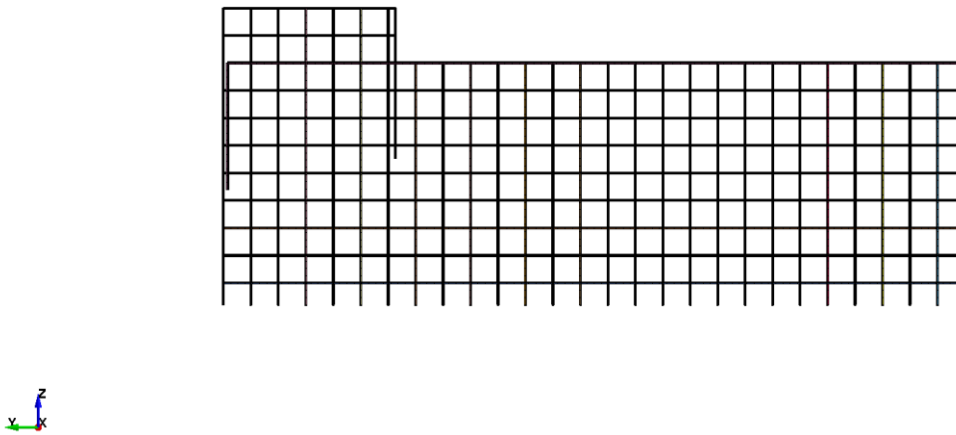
Vista de Acero en Modelo Estribo Simple de Puente Águila Norte.
